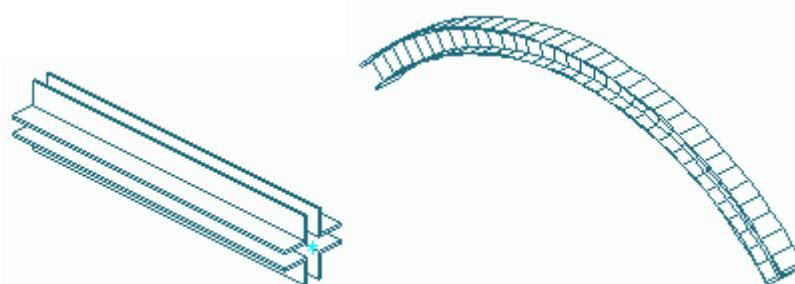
Section composée et poutre cintrée, affichées avec la représentation AutoCAD 'arêtes Cachées'
